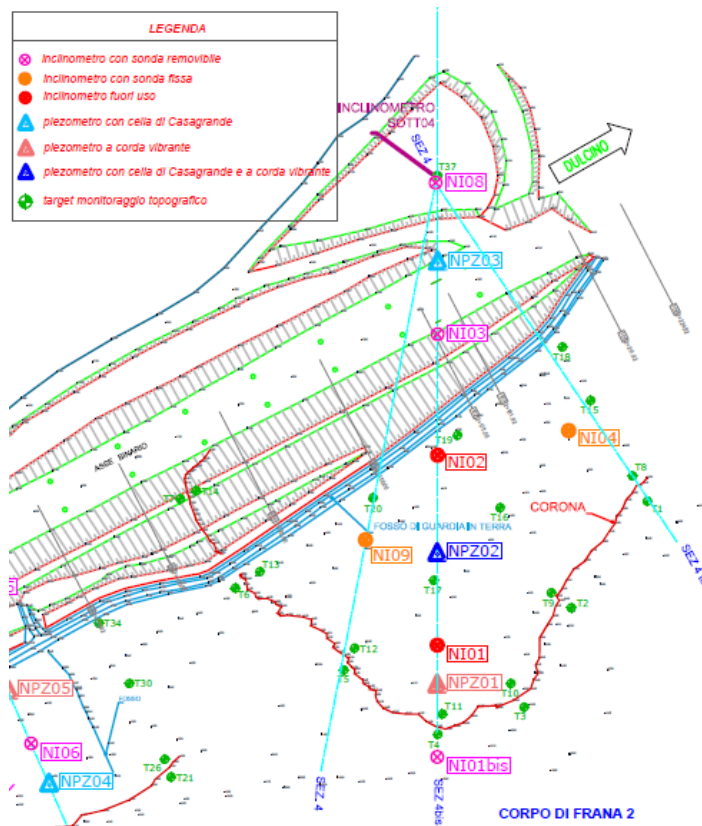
Planimetria di ubicazione della strumentazione attualmente attiva nel Corpo di Frana 2, (2020).
